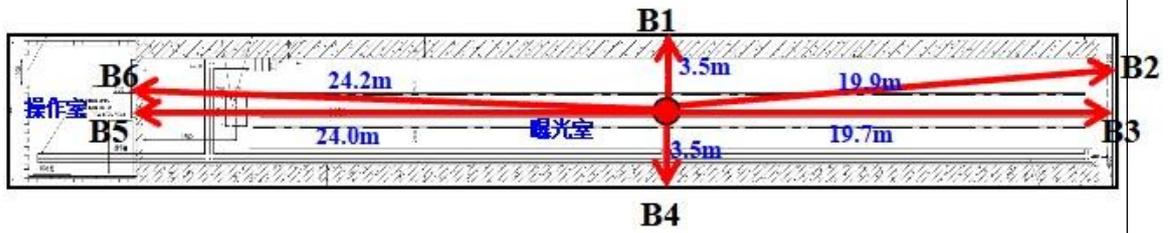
4#探伤室射线源到周围屏蔽体距离图（平面图）
